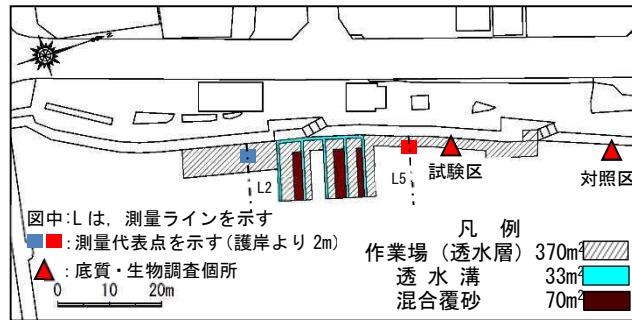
作業場構築範囲を示す試験区の施工平面図<sup>7)</sup>
